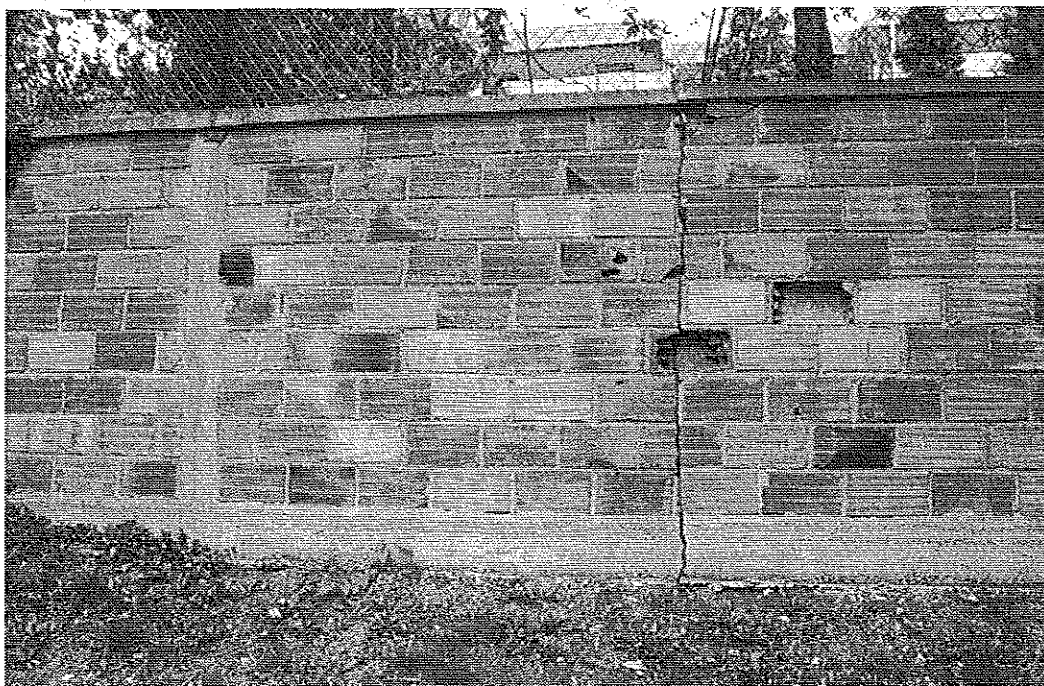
Fissure verticale dans le mur de clôture concernant la partie en briques, la longrine de fondation et le couronnement. © J. Putatti
